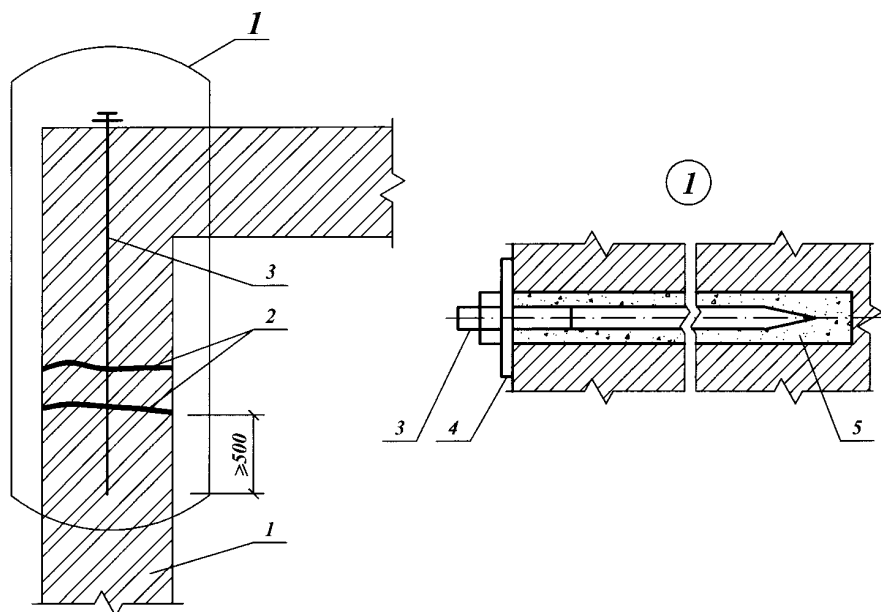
Усиление стен с трещинами в углах зданий или в примыкании поперечных стен к продольным:
